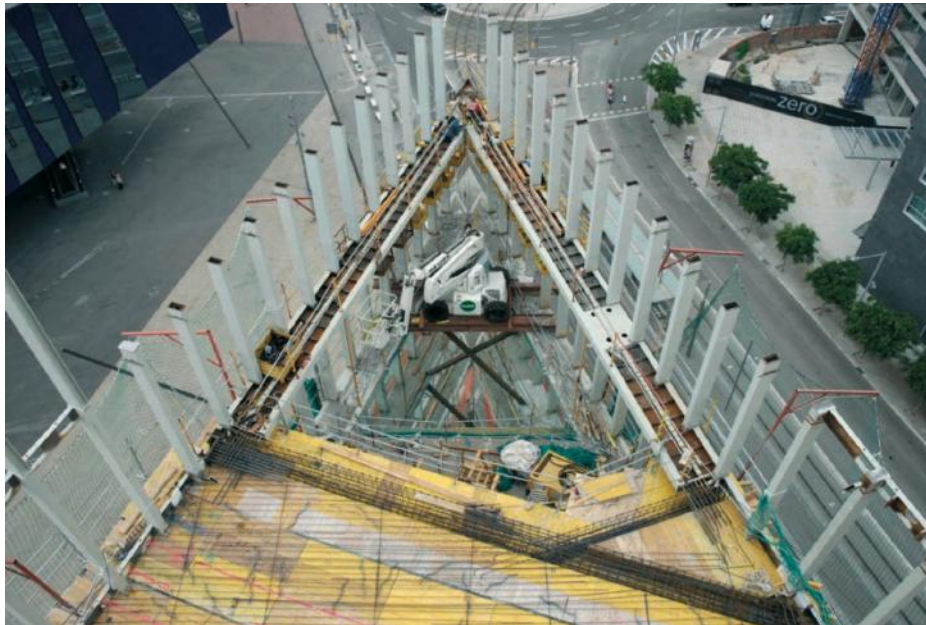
Proceso constructivo vigas y soportes II
